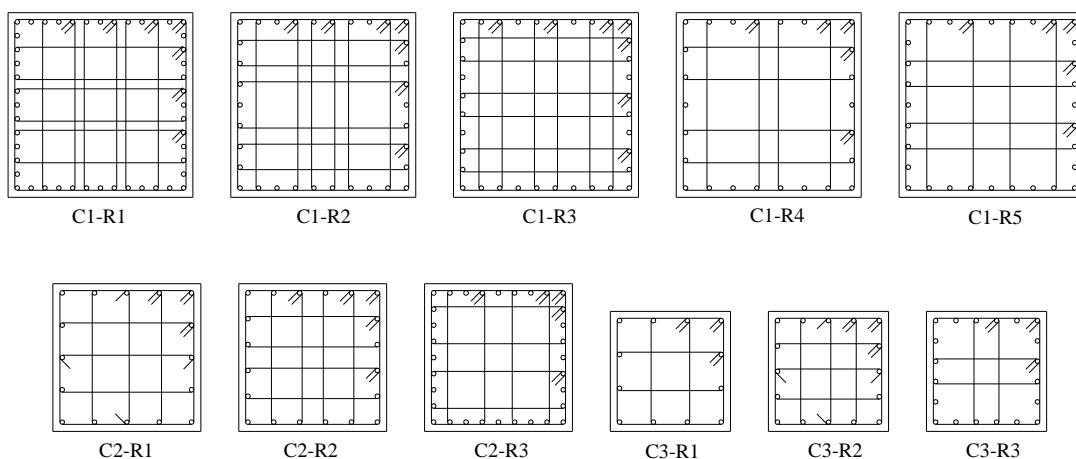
Secciones y refuerzo de las columnas del modelo DQ4CP
